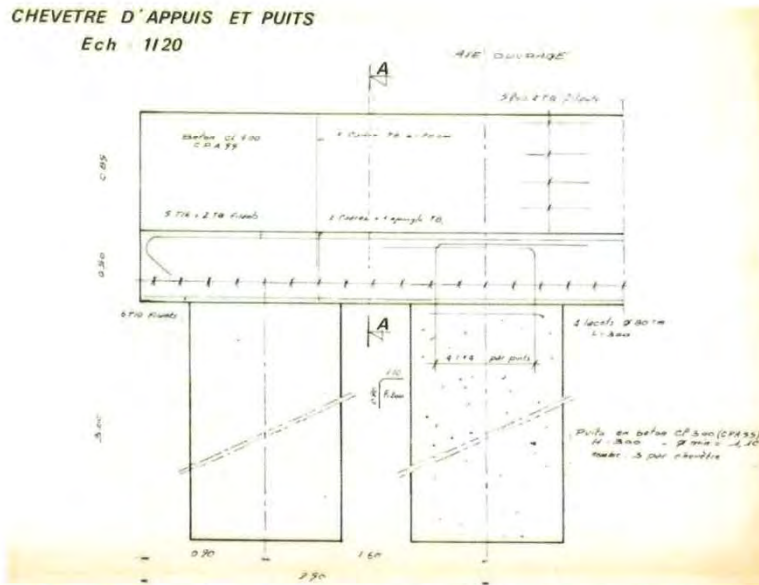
Coupe transversale d'une demi-culée (Extrait du plan d'archives)
